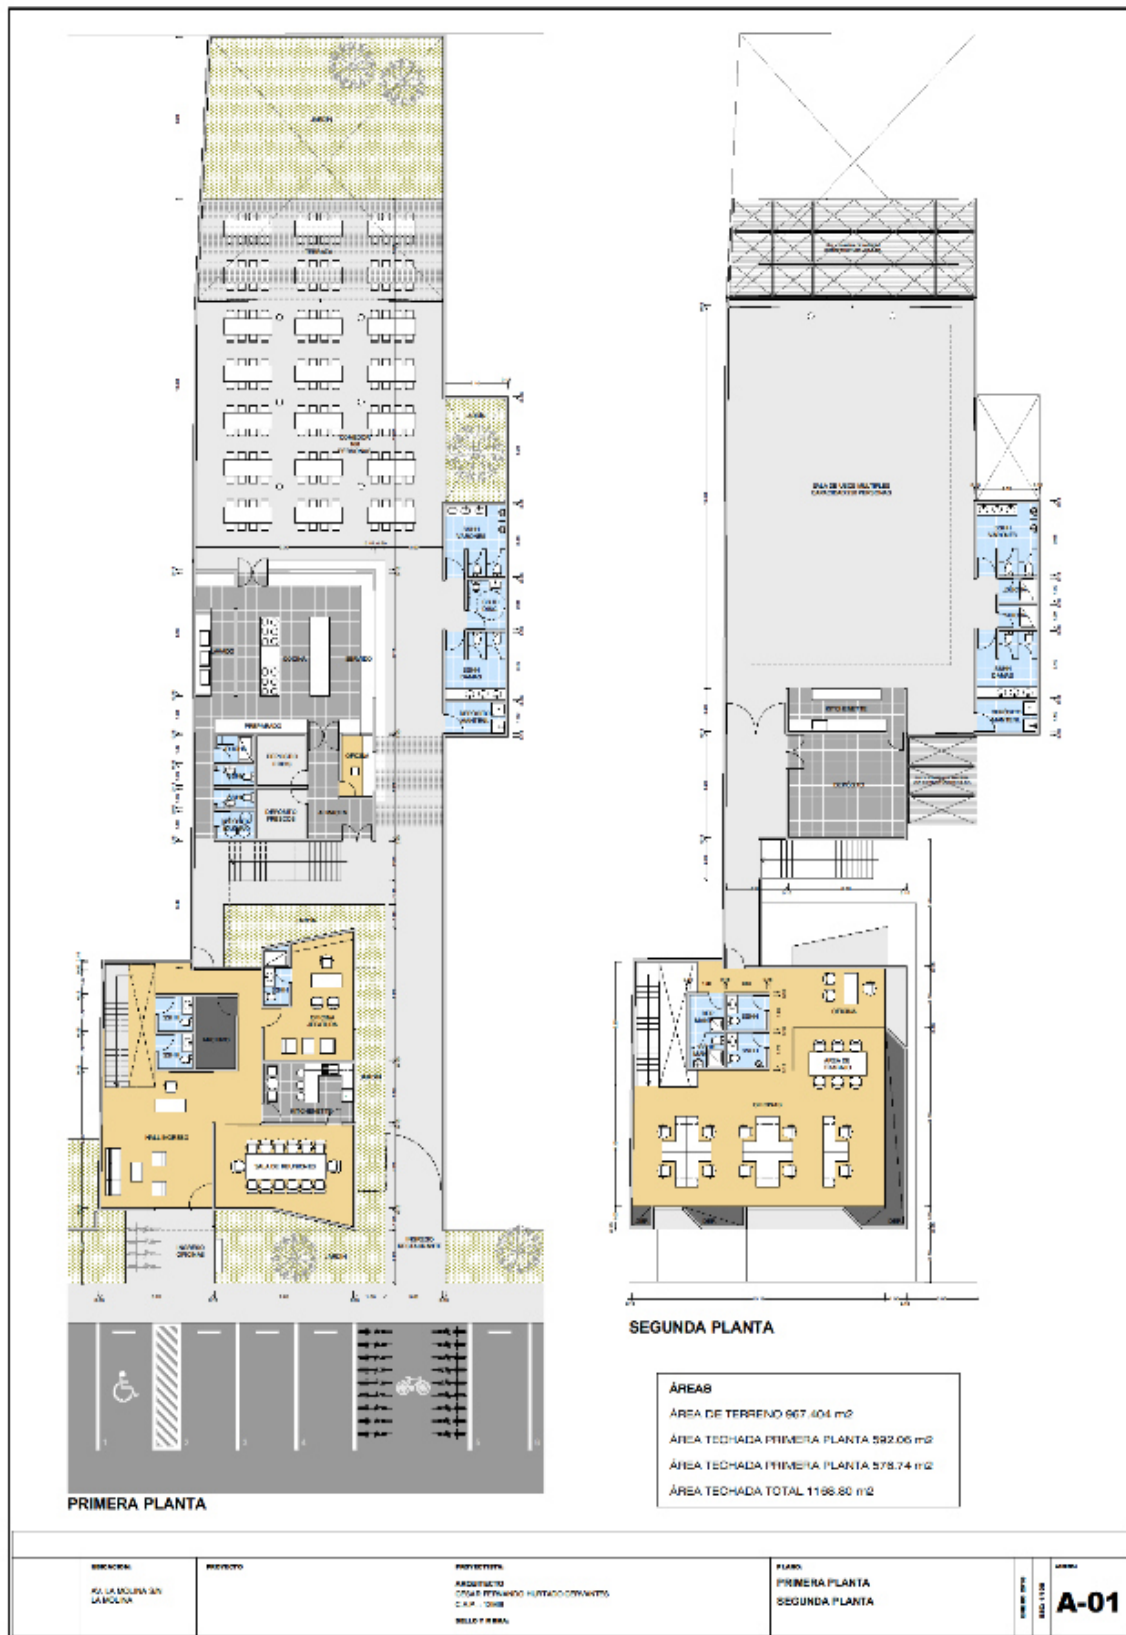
Vista en planta del proyecto, propuesta arquitectónica
